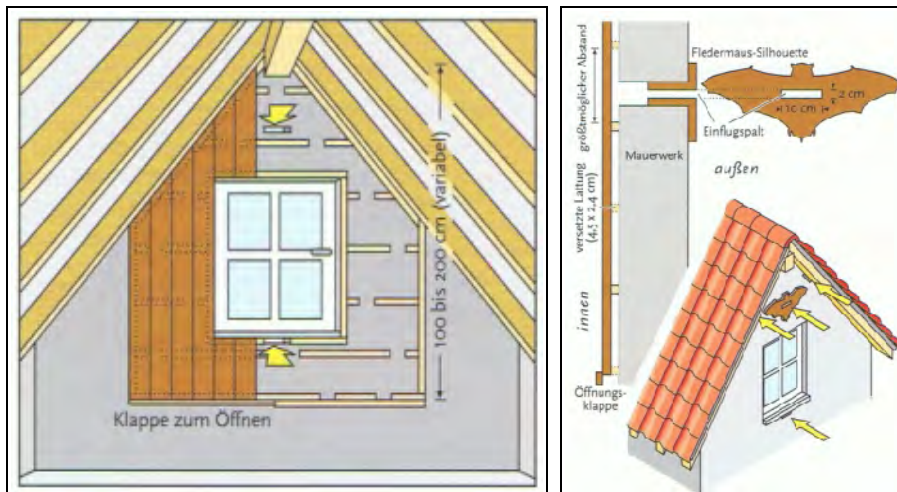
Spaltenquartier als Giebelverkleidung im Dachinneren mit Zugang von außen (unter Fensterbrett, Dachbalken oder oberhalb des Fensters)¹³
